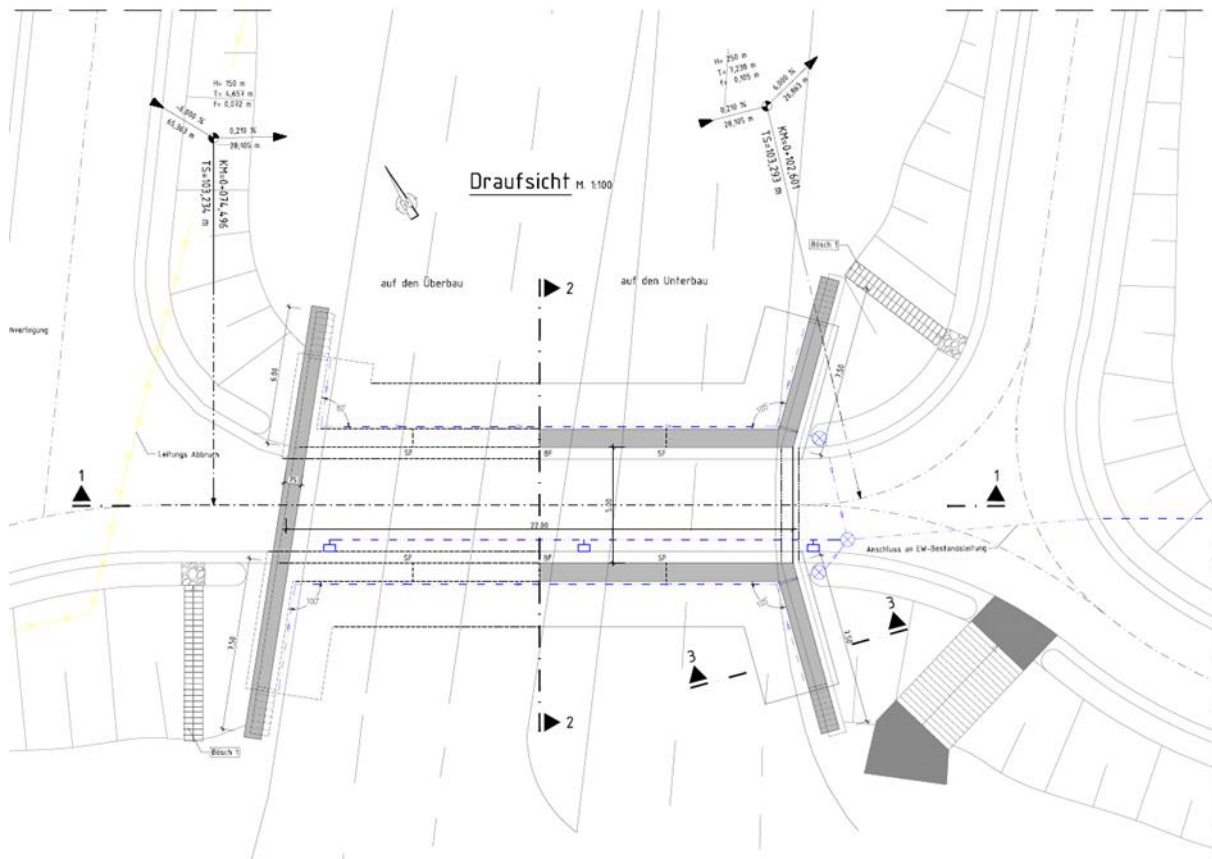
Draufsicht Bauwerksplan, Unterführung Machbarkeitsstudie (Büro BUNG 2023)
